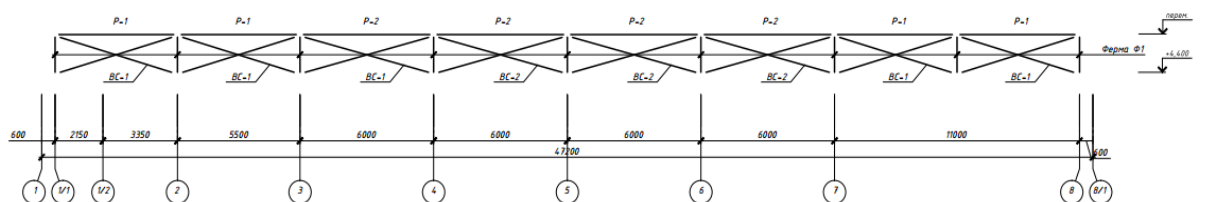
Схема расположения фермы Ф-1 на отм. + 4.400
